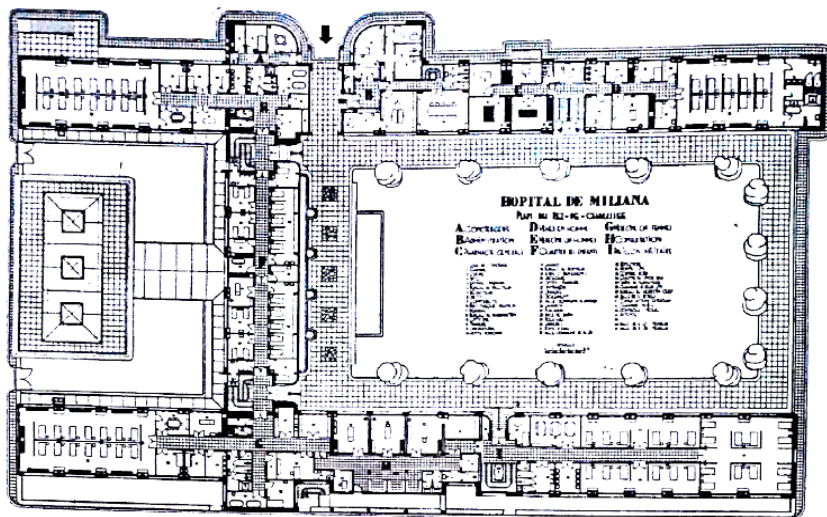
Plan de l'hôpital de Miliana, Xavier Salvador.
